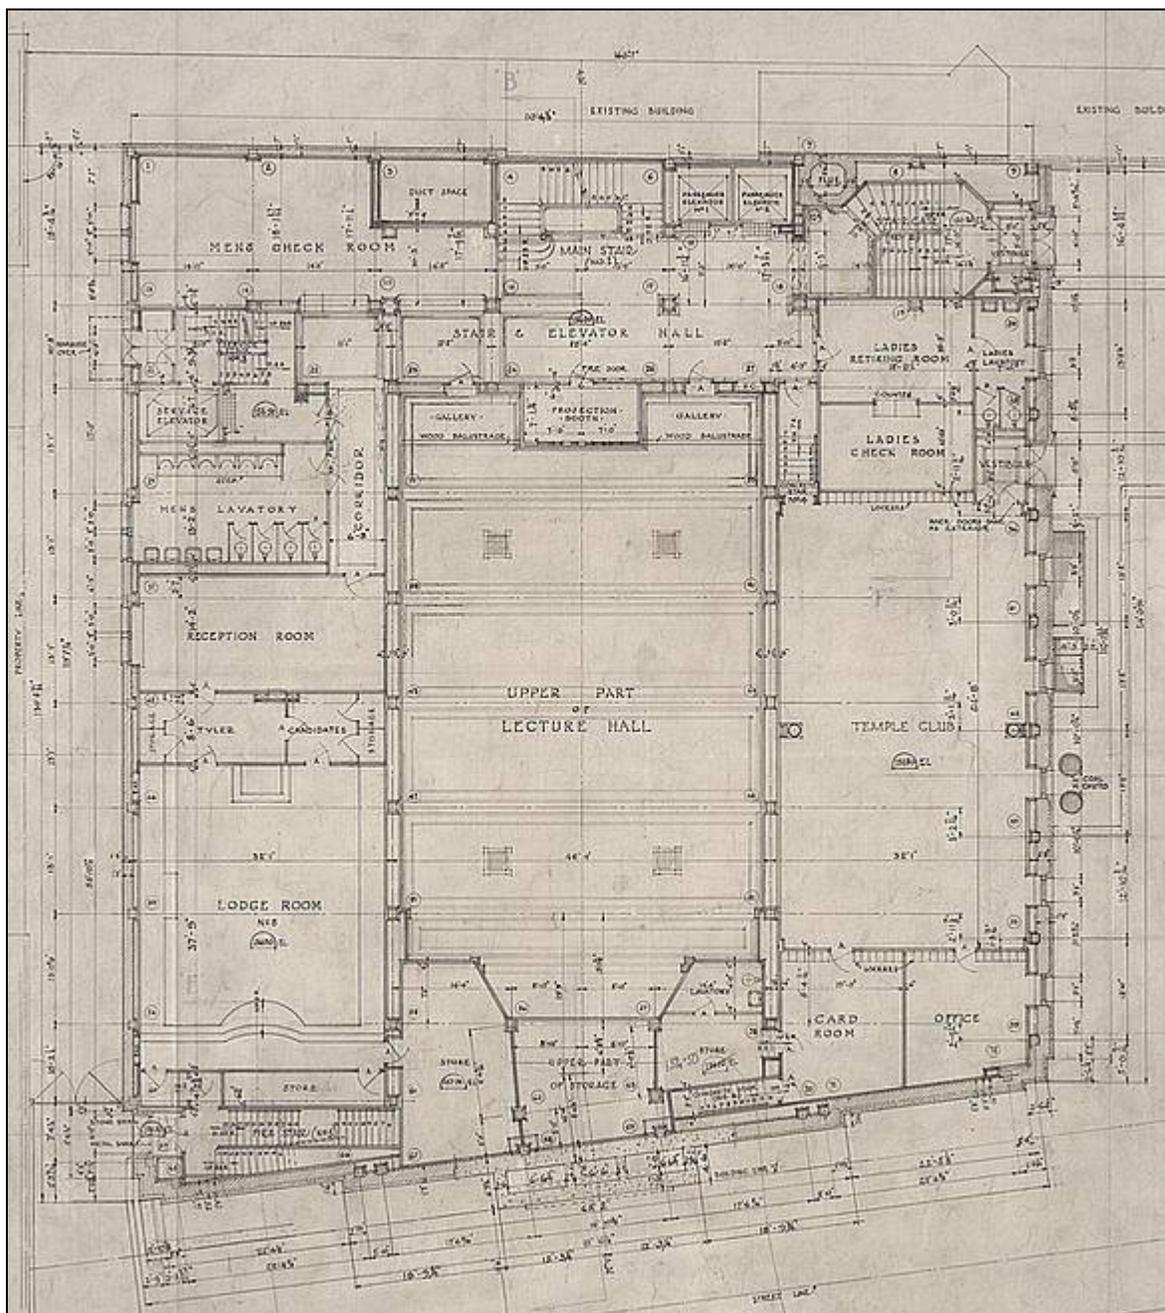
Plan du *basement mezzanine*, ou étage n° 2 (détail de la feuille du plan). Plans de John S. Archibald, Université McGill, collection CAC.
